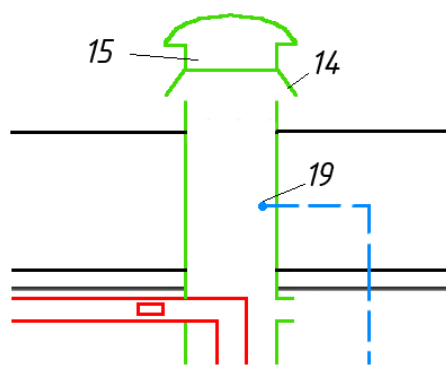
Вариант исполнения системы воздухоудаления вертикальной вытяжной шахты устройства тепловой вентиляции с крышным вентилятором
